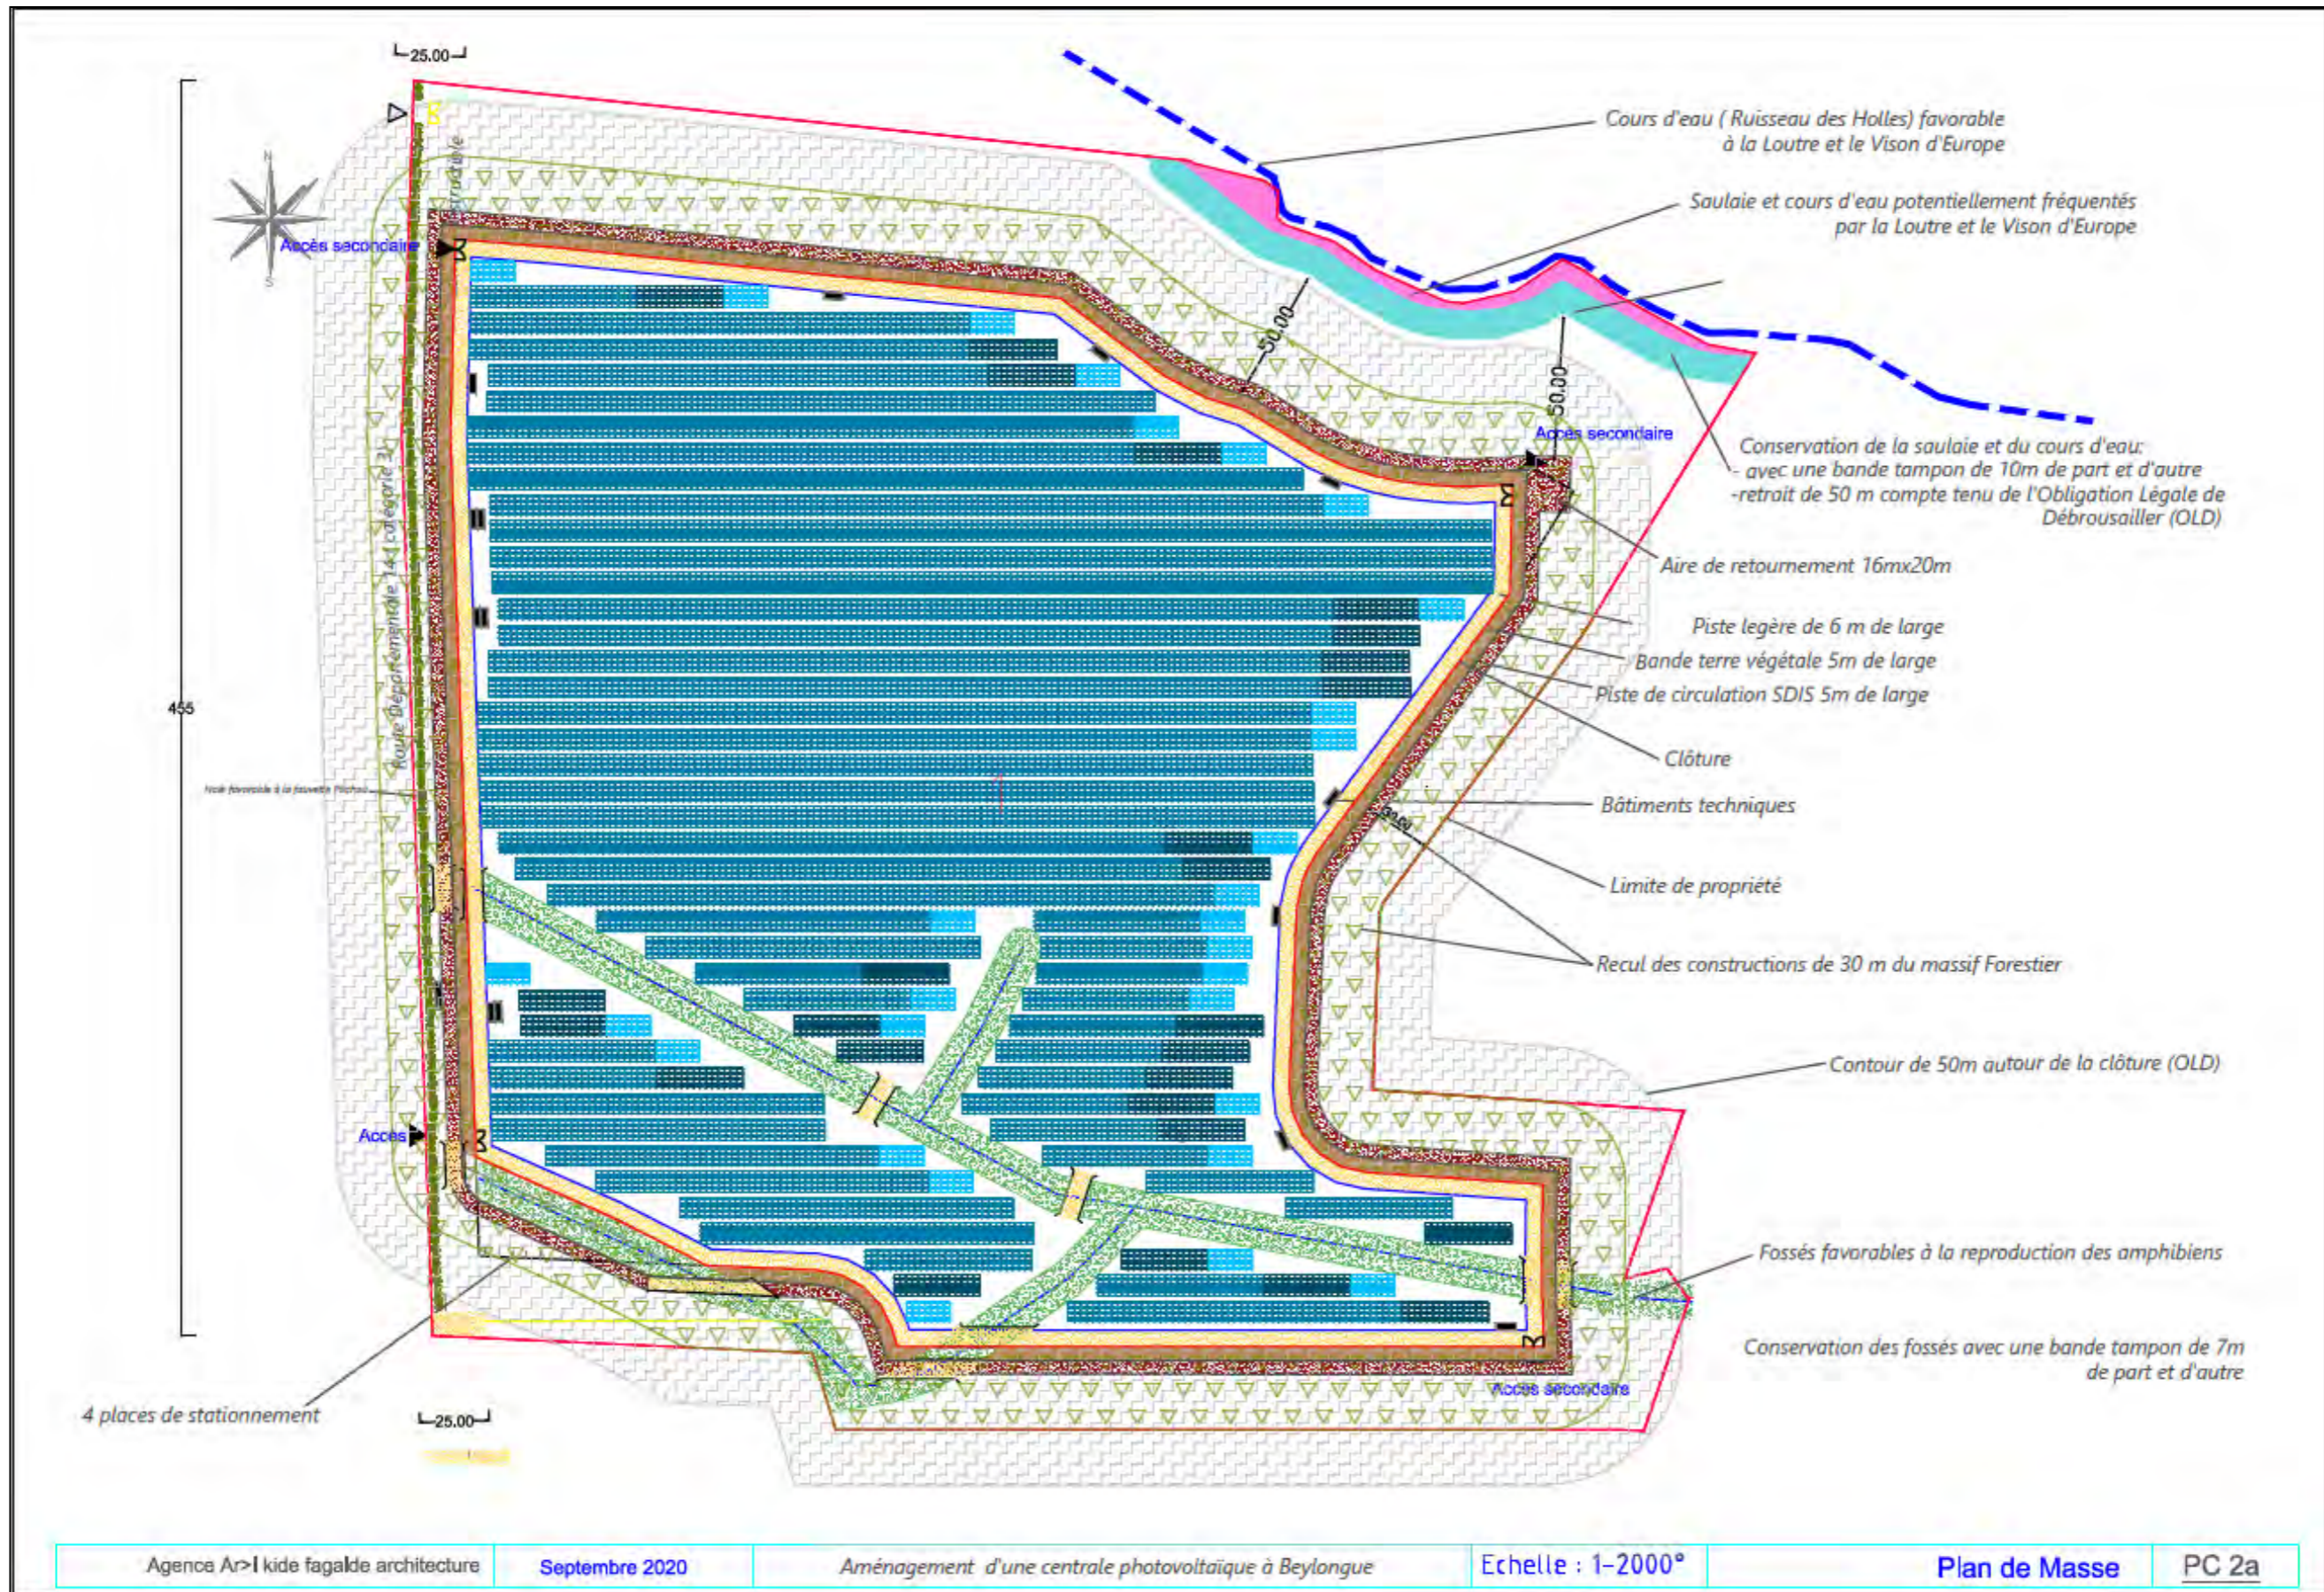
Plan de masse du projet (source : wpd, Août 2021)
